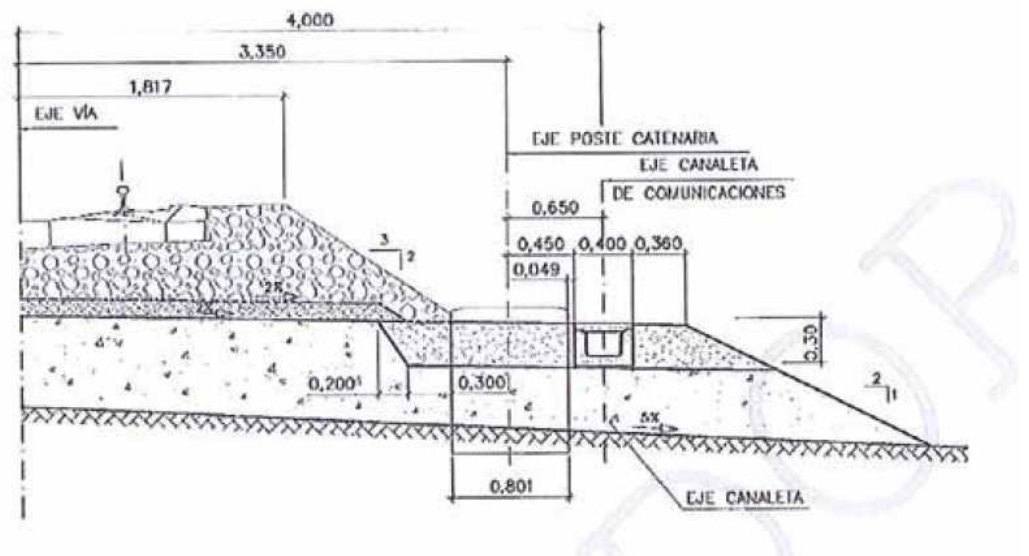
Detalle de la sección constructiva de Villodrigo-Villazopeque (Fuente:ADIF)
